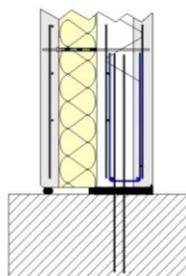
Liaison couturée avec plancher bas (boîte d'attente ou réservation horizontale pour attentes posées sur chantier)
